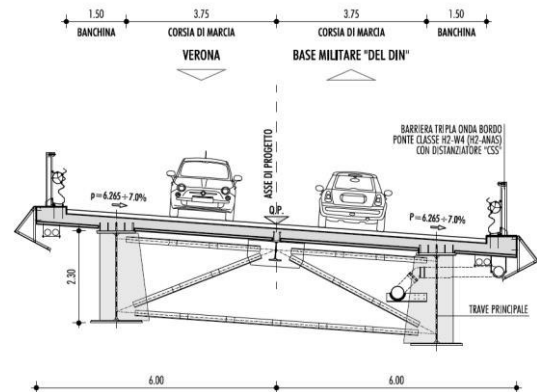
SEZIONE TIPO DEL PONTE SUL TORRENTE OROLO
